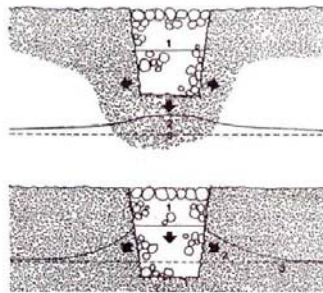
Pozos de infiltración (arriba) y de inyección (abajo). 1.- Pozo, 2.- Agua subterránea, 3.- Nivel estático.
